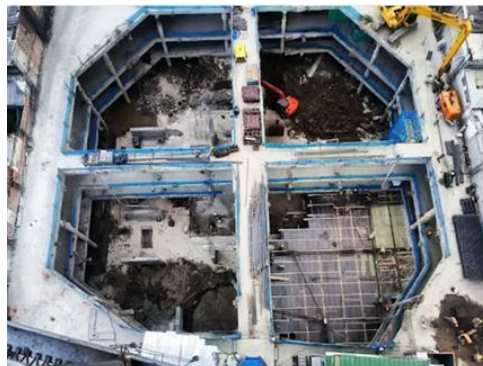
Vista general Proceso constructivo de sótanos Fuente: Propia
